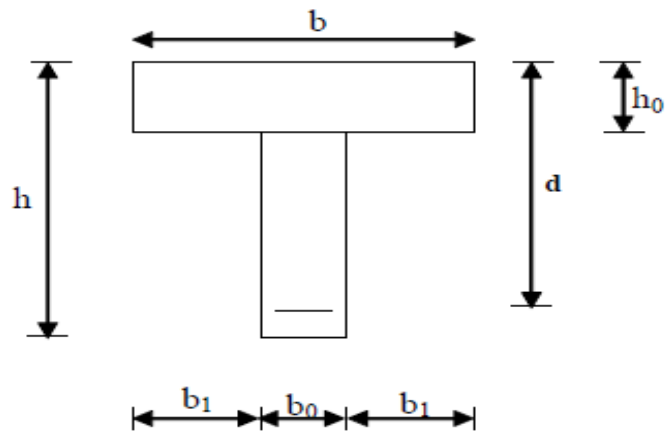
Section de calcul de poutrelle après coulage de la dalle de compression aux travées.
